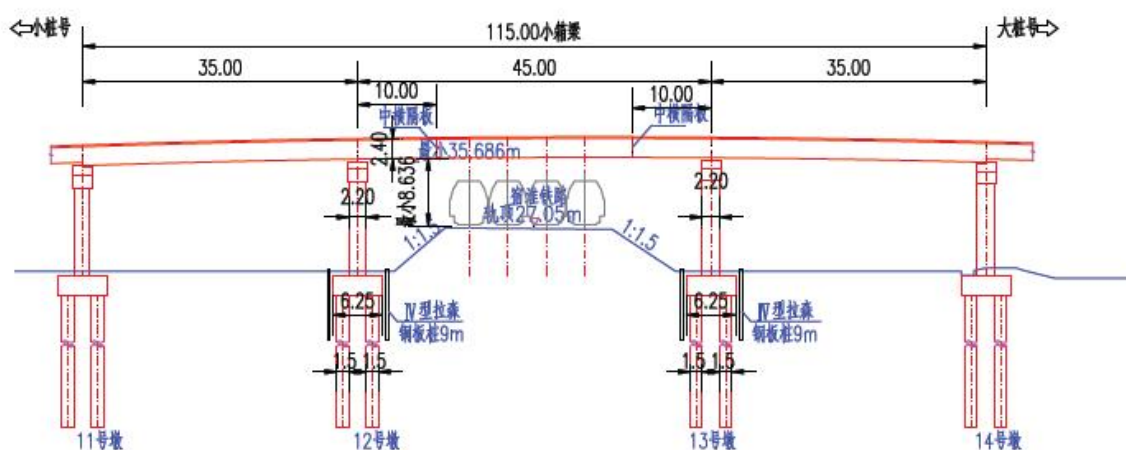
主线跨铁段主桥总体布置图(单位: m)
